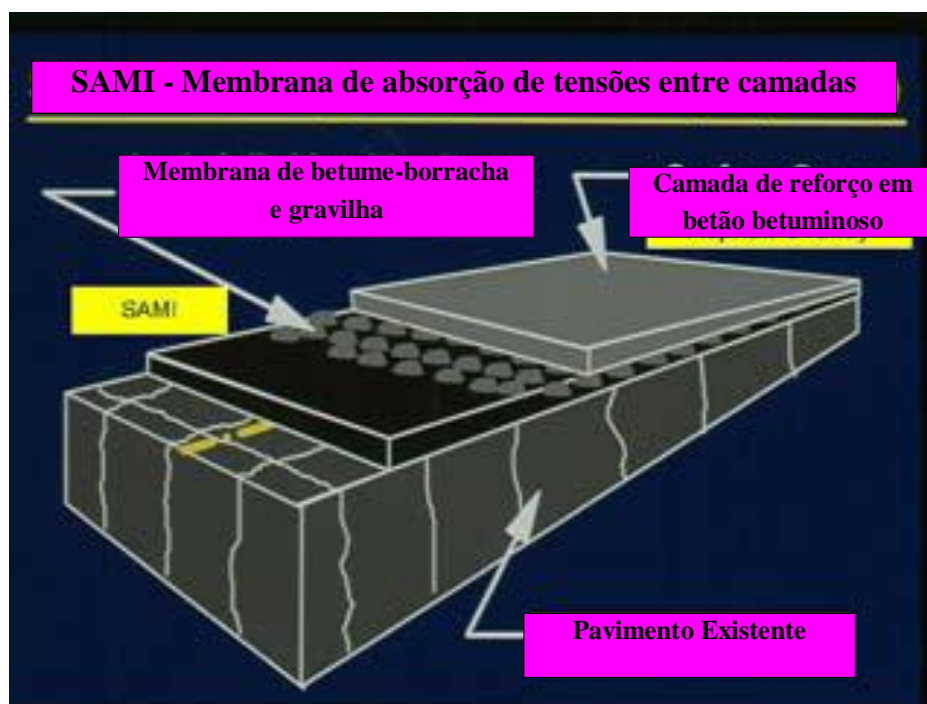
SAMI de Betume-Borracha (adaptado de Zareh e Way, 2009)
